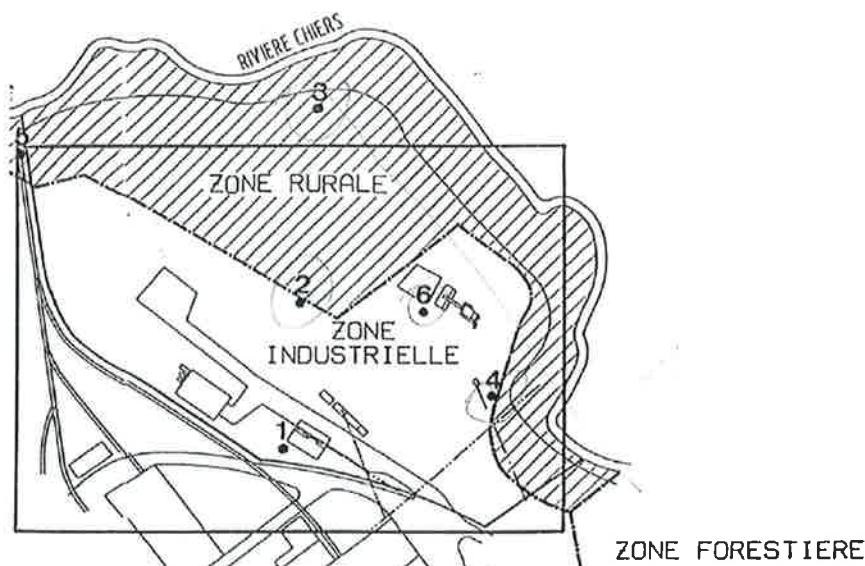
Plan d'implantation des points de forages (F1-F6) – rapport Luxcontrol S.A. n°93202.1 ROM – 21.01.1994
